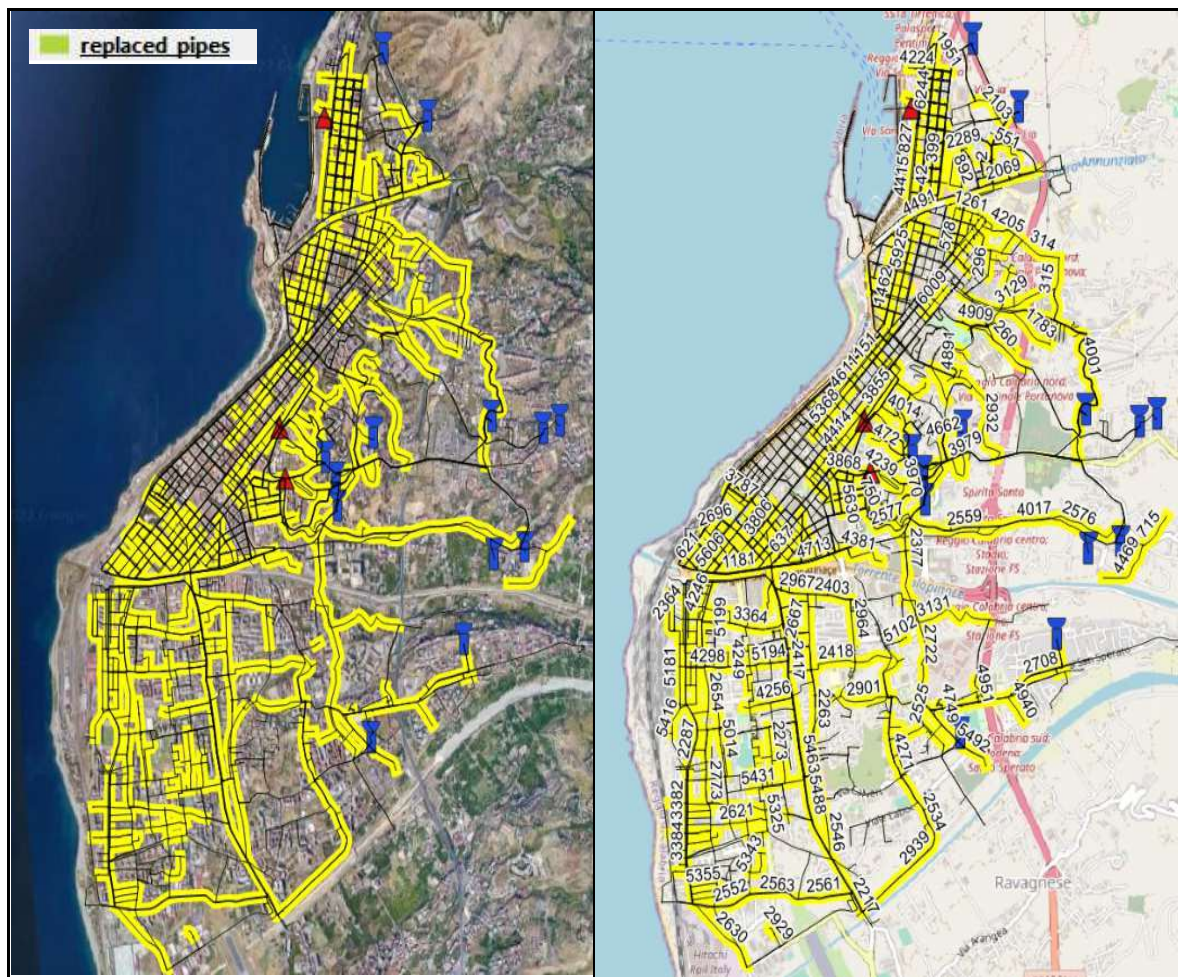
Stralcio Planimetrico delle condotte da sostituire - Piano di Riabilitazione n.10
